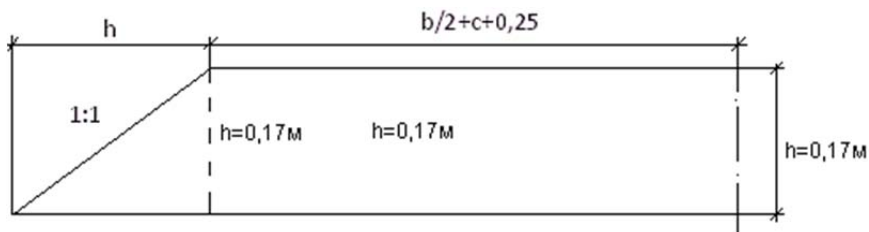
Схема для расчета площади поперечного сечения основания из ПГС
